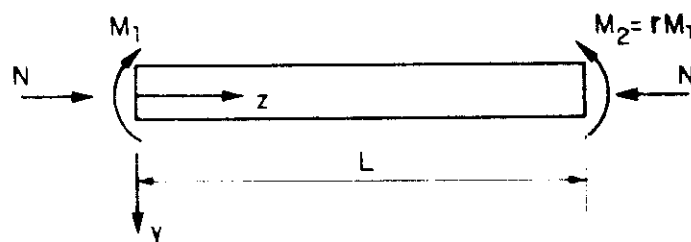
Barra prismática sujeita à compressão e flexão no plano.
